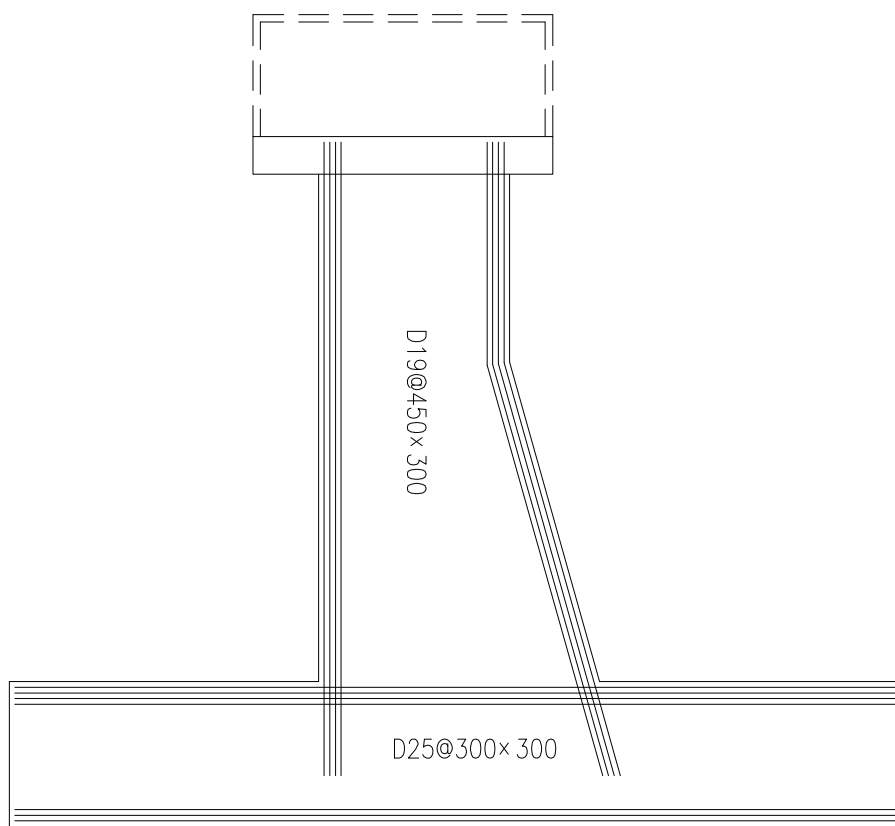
概略せん断補強筋配置図 (A-A断面)
